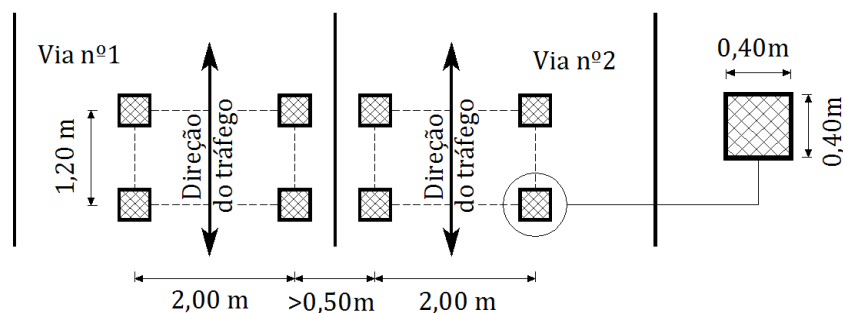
Disposição em planta dos veículos do LM1 para verificações locais
